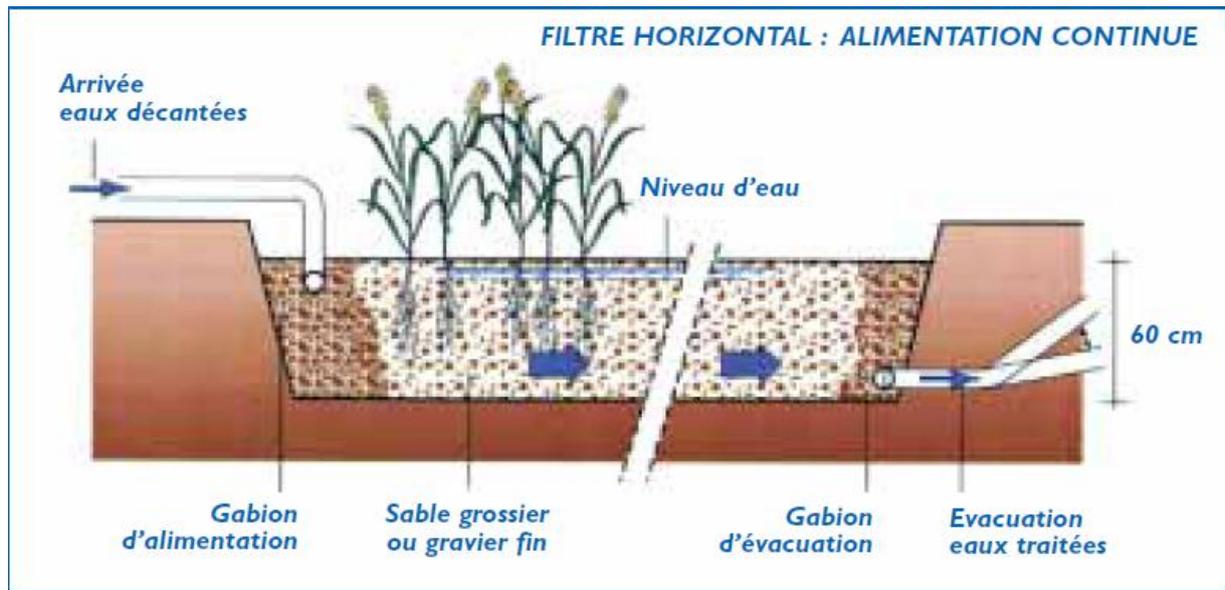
Schéma d'un lit horizontal en coupe transversale
